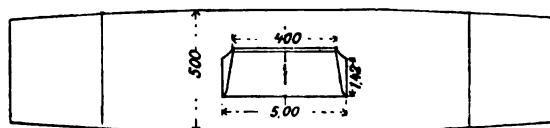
und 190. Grundriß-Querschnitt 1 : 300.
